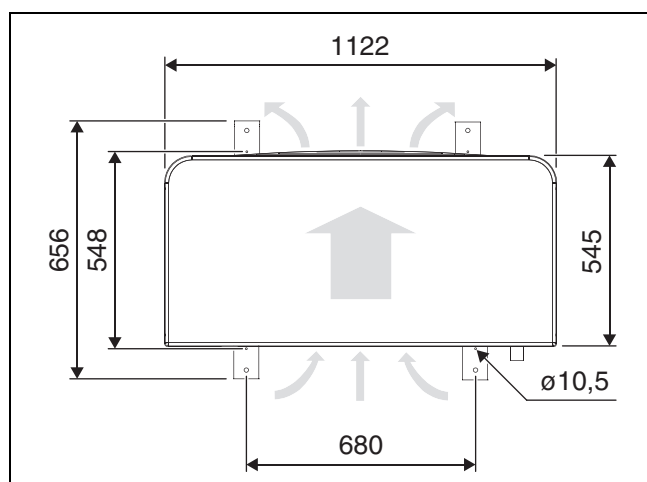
Dimensioni del modello di pompa di calore 13-17, vista dall'alto
